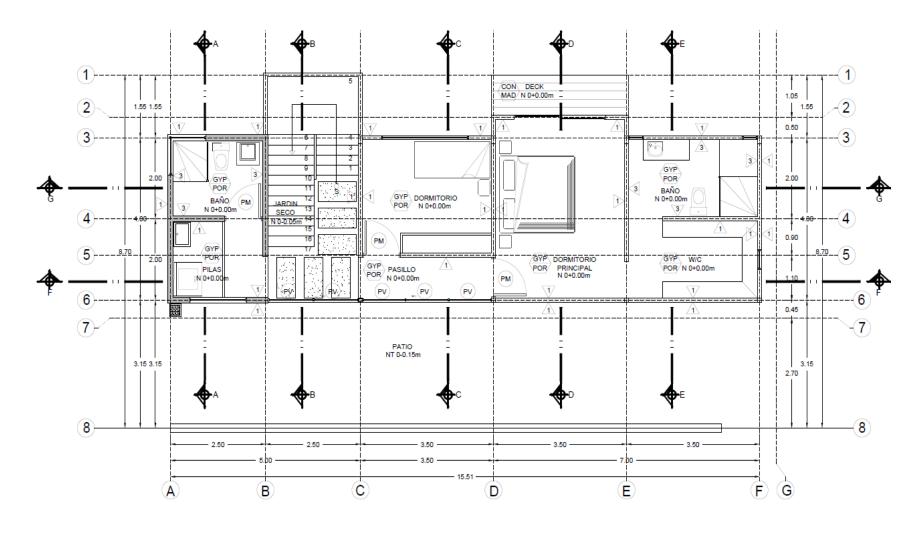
Planta arquitectónica Primer Nivel. Fuente: AE Diseño y Arquitectura, 2019.
